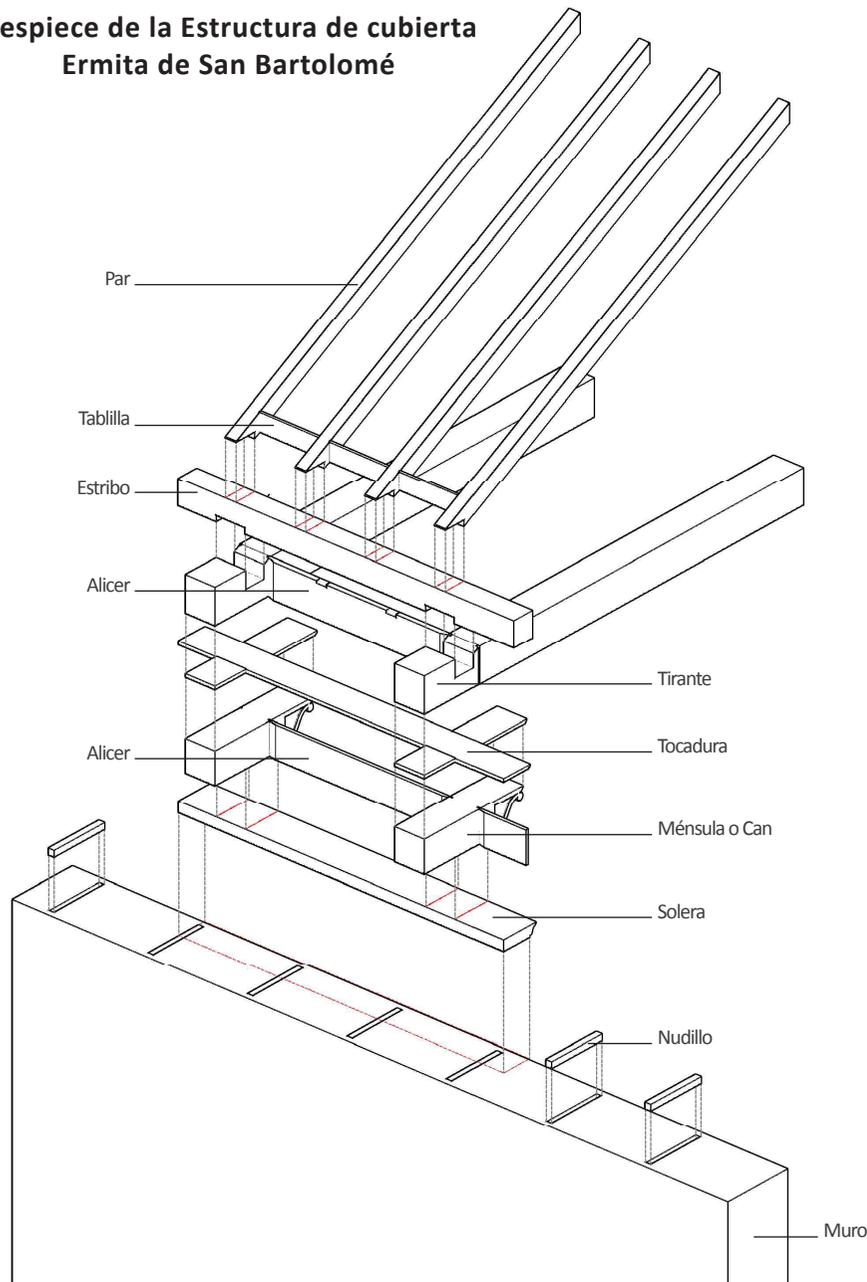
Detalle constructivo de la estructura de cubierta de la Ermita de San Bartolomé
